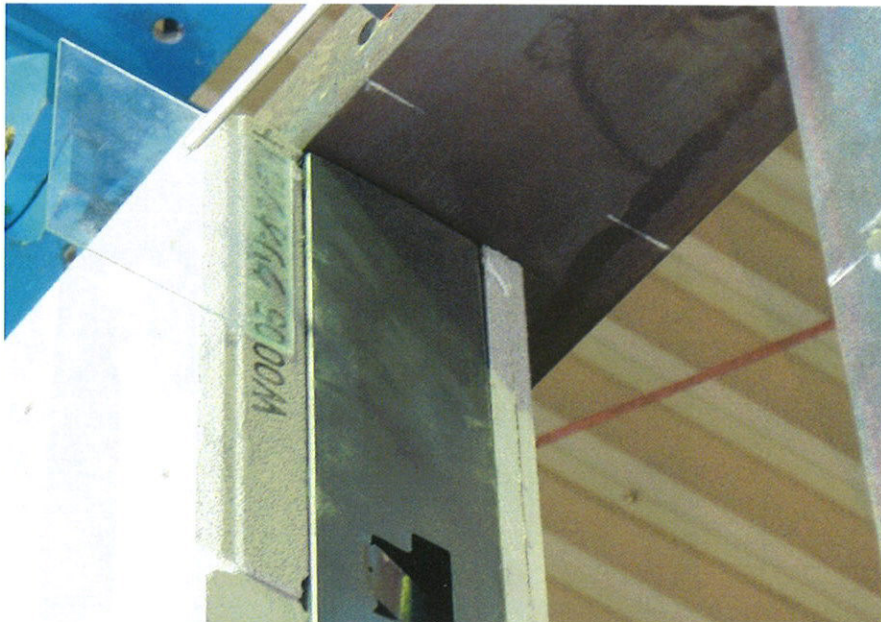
試験体の状況 (+1/200rad. : せっこうボードの割れ)
